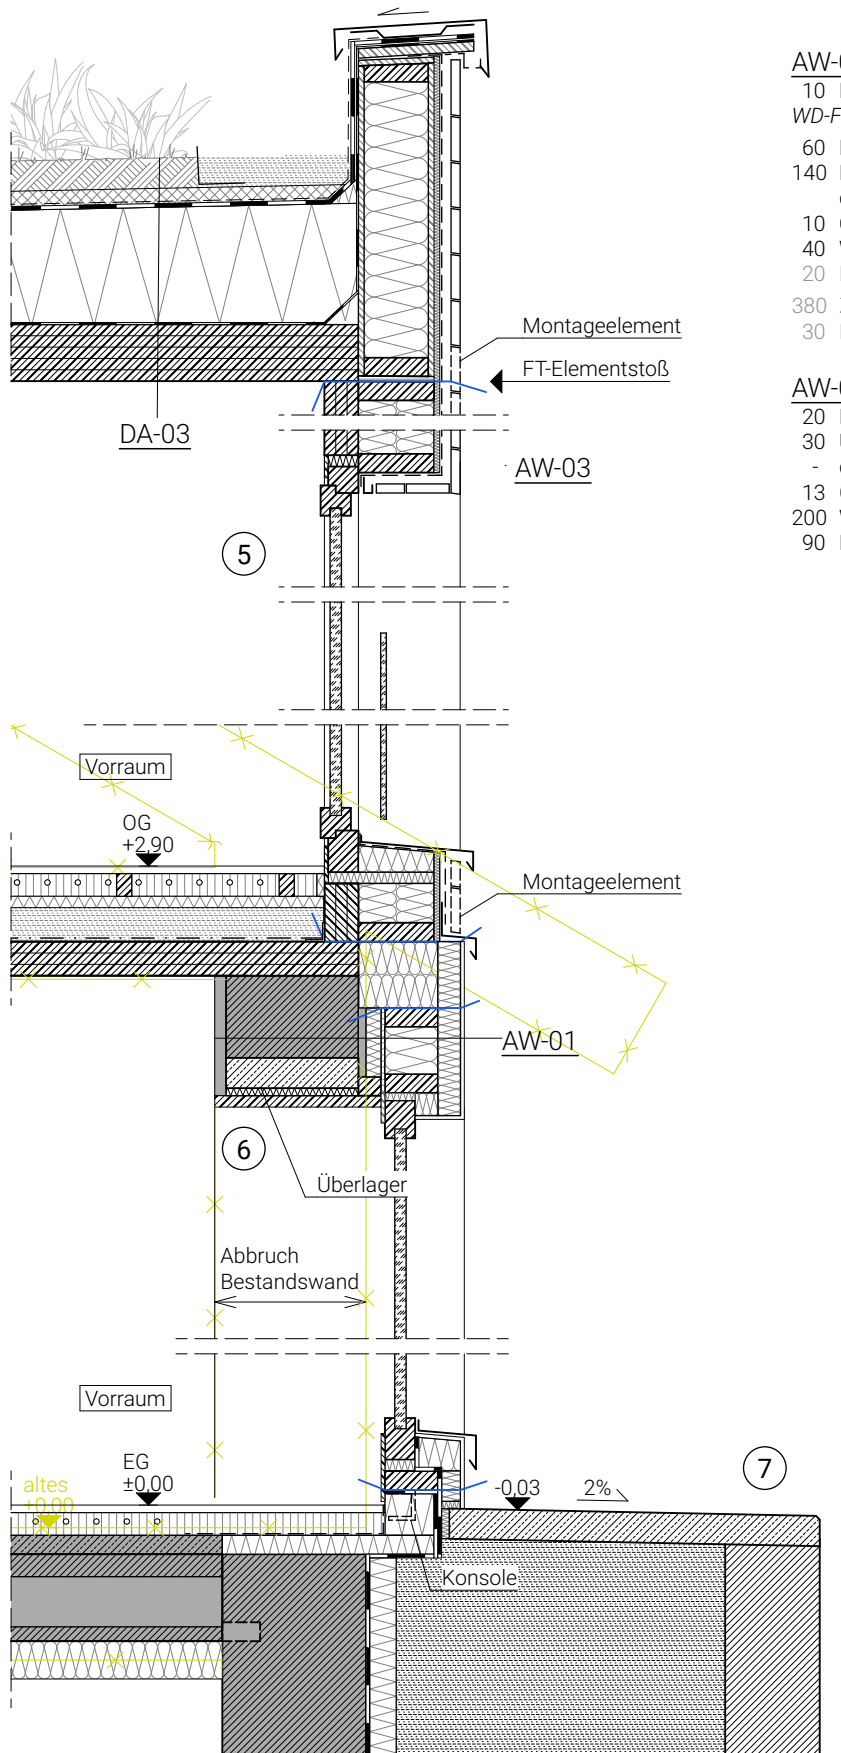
Fassadenschnitt Erweiterung Südostfassade
